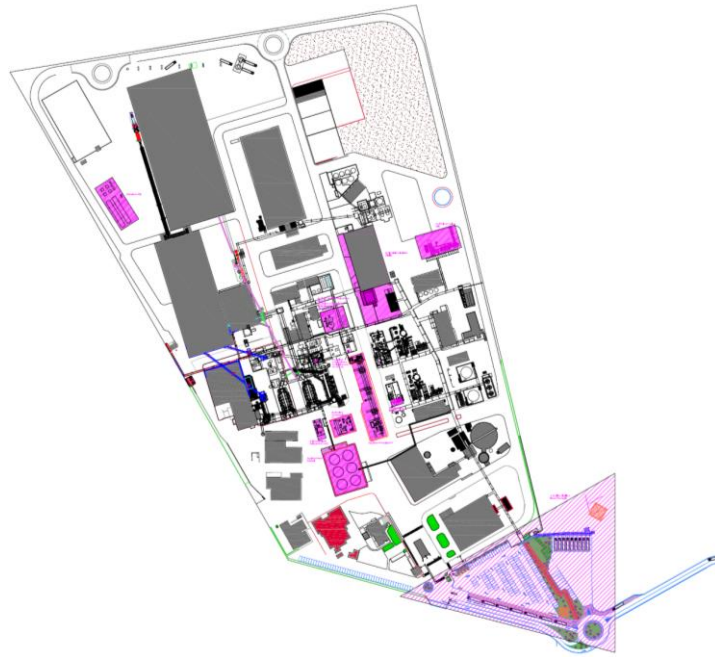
Planimetria dell'impianto Fluorsid (sono evidenziate a colori le aree oggetto degli interventi)
